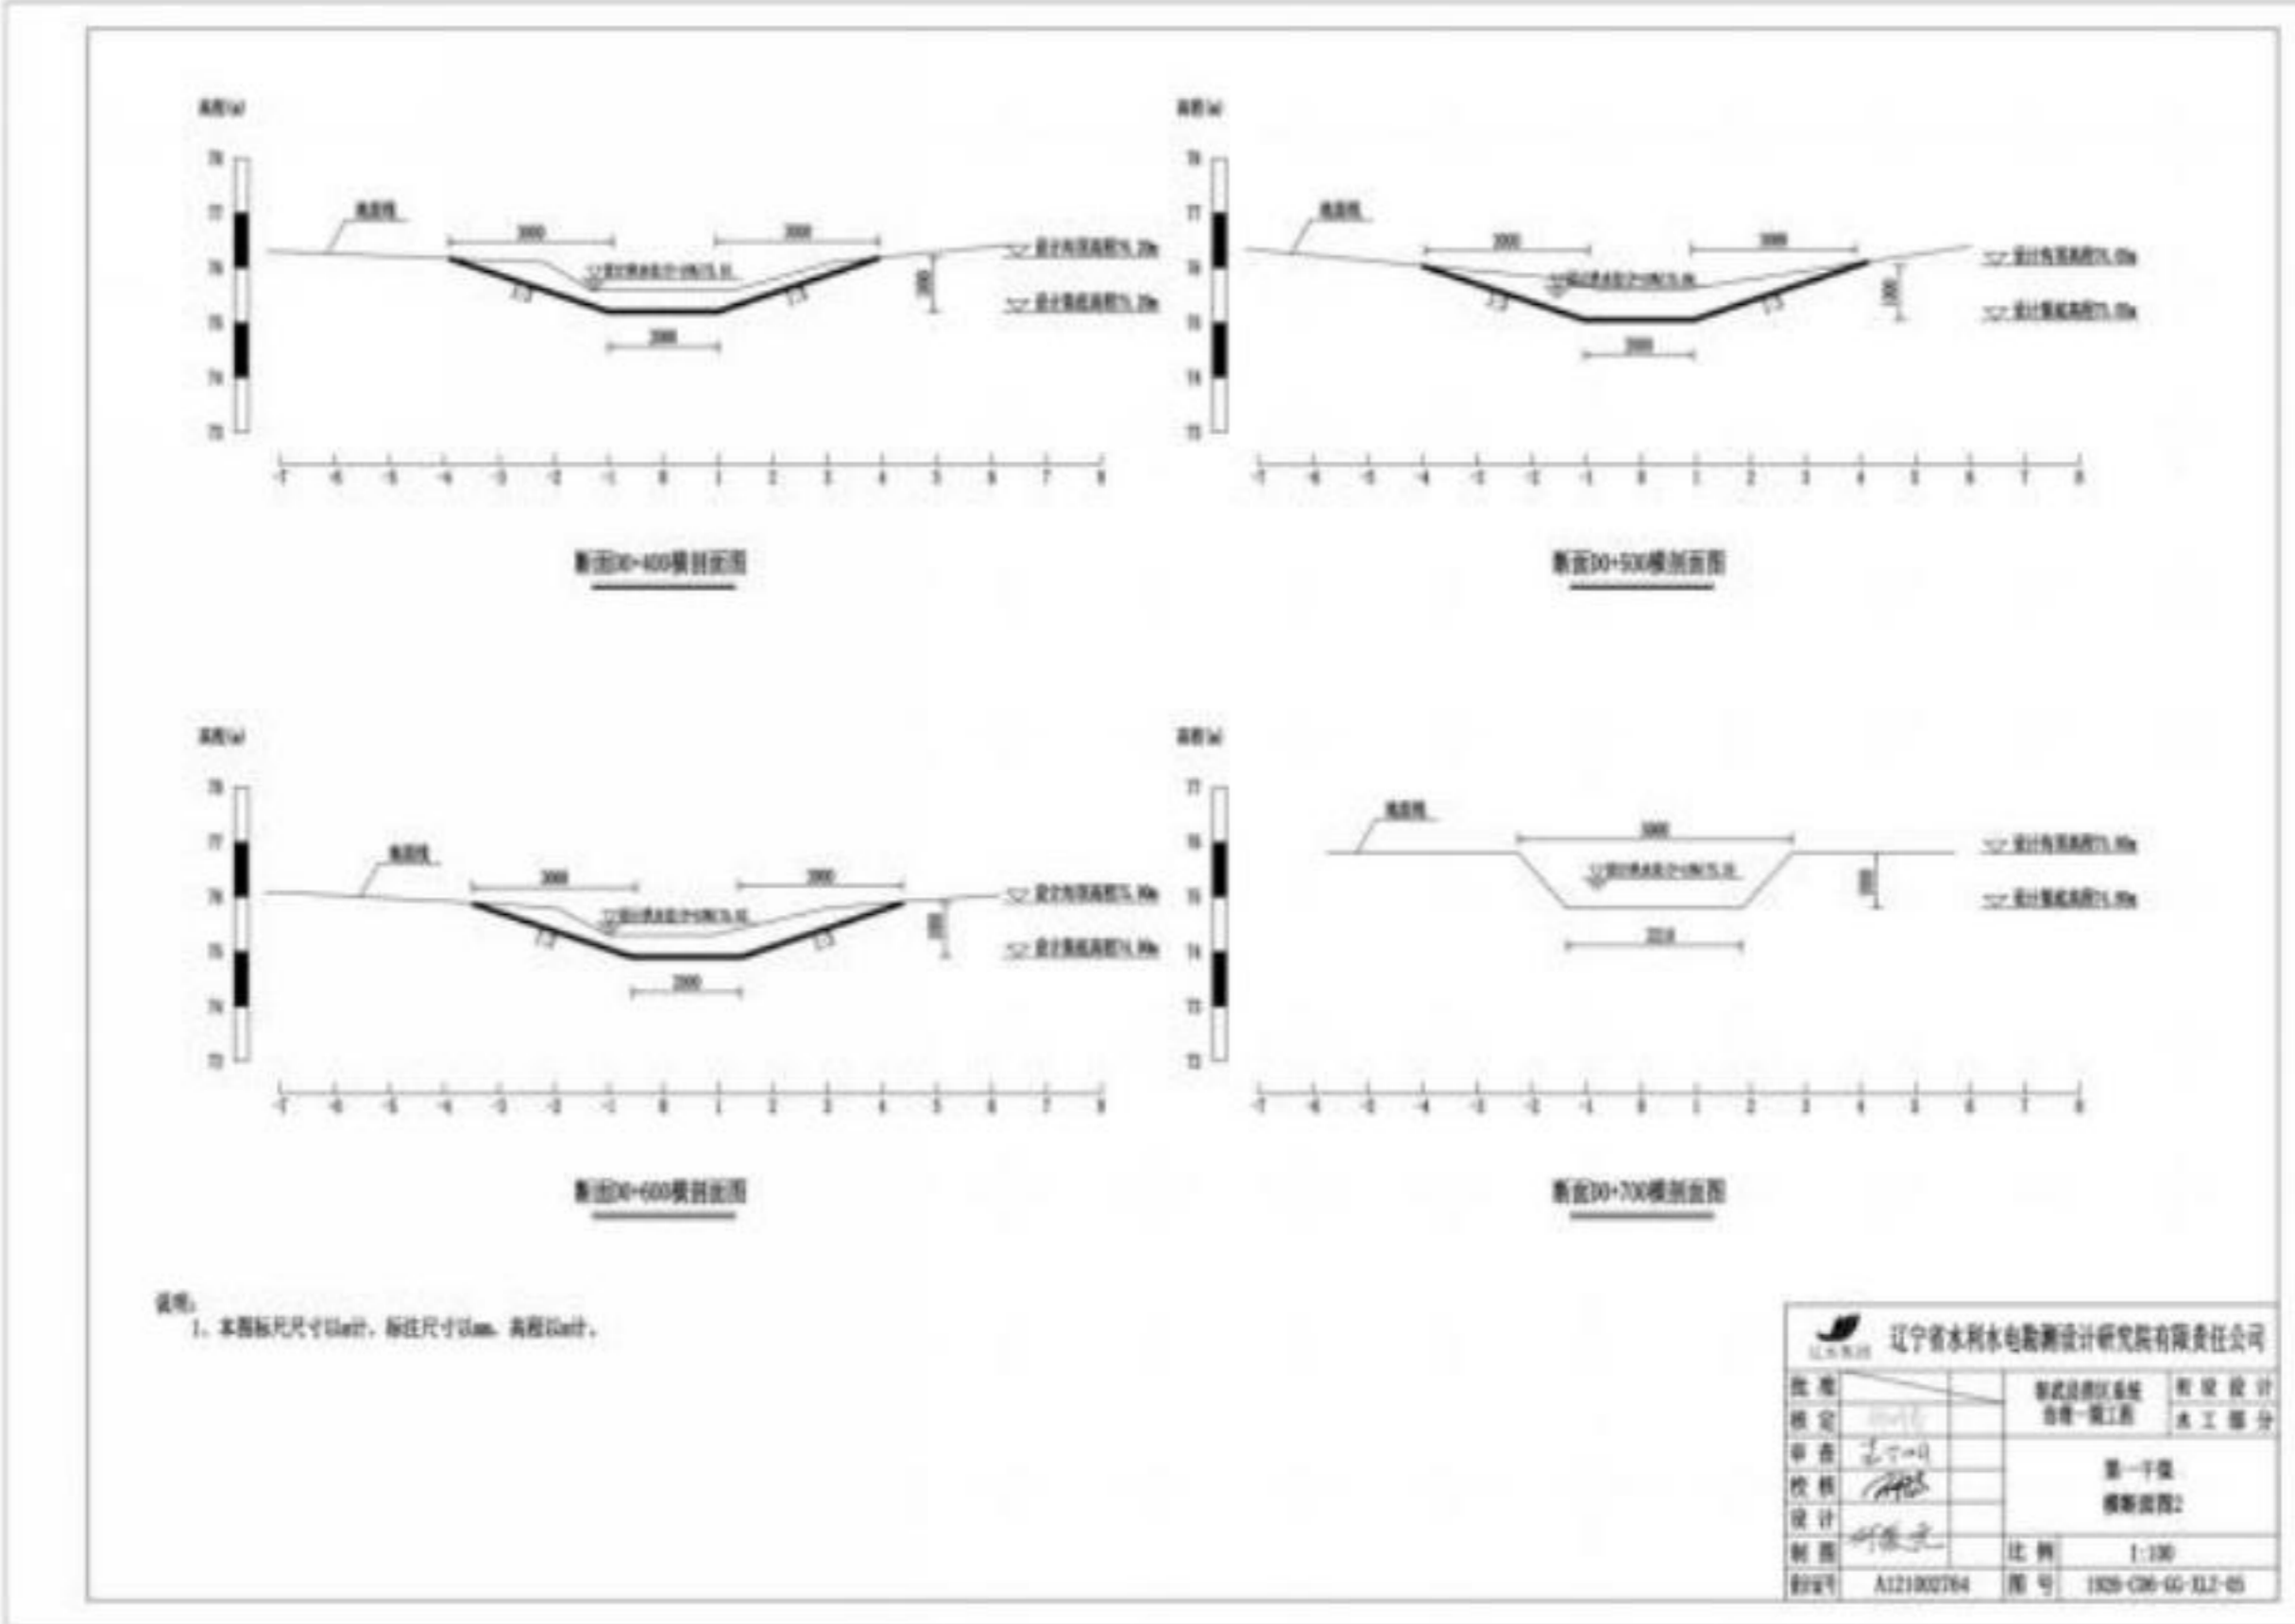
(2) 西六家子镇第一干渠剖面图
